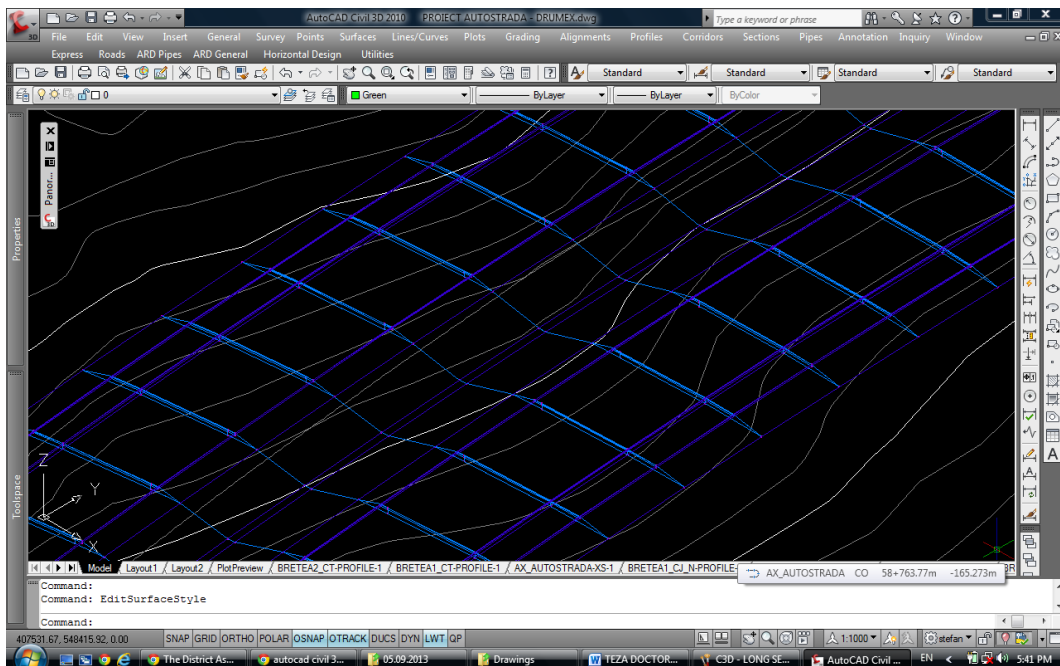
46 Crearea unui coridor prin combinarea elementelor din plan, profil longitudinal și profil transversal
